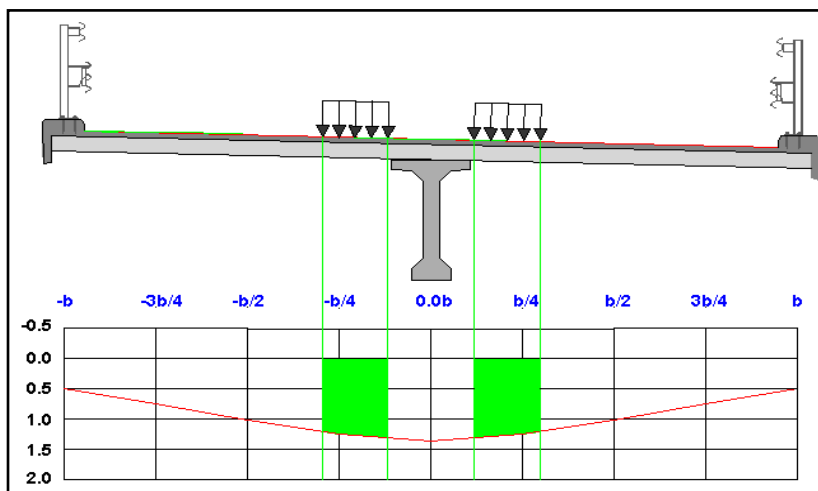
Chargement Mc120 sur Li de la poutre 1
